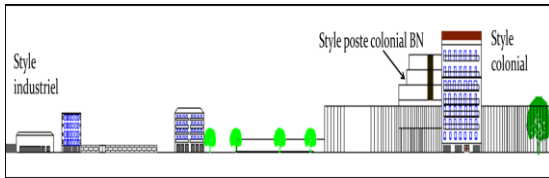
Façade sur le boulevard Med Belouizded (nord)
